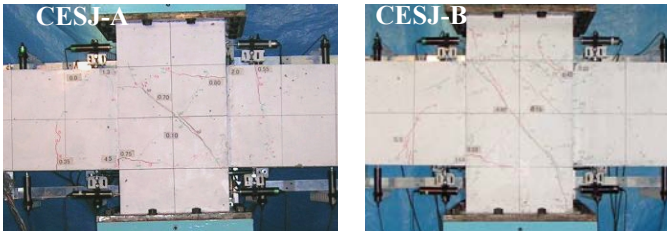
ひび割れ状況 (R=0.015rad.)
